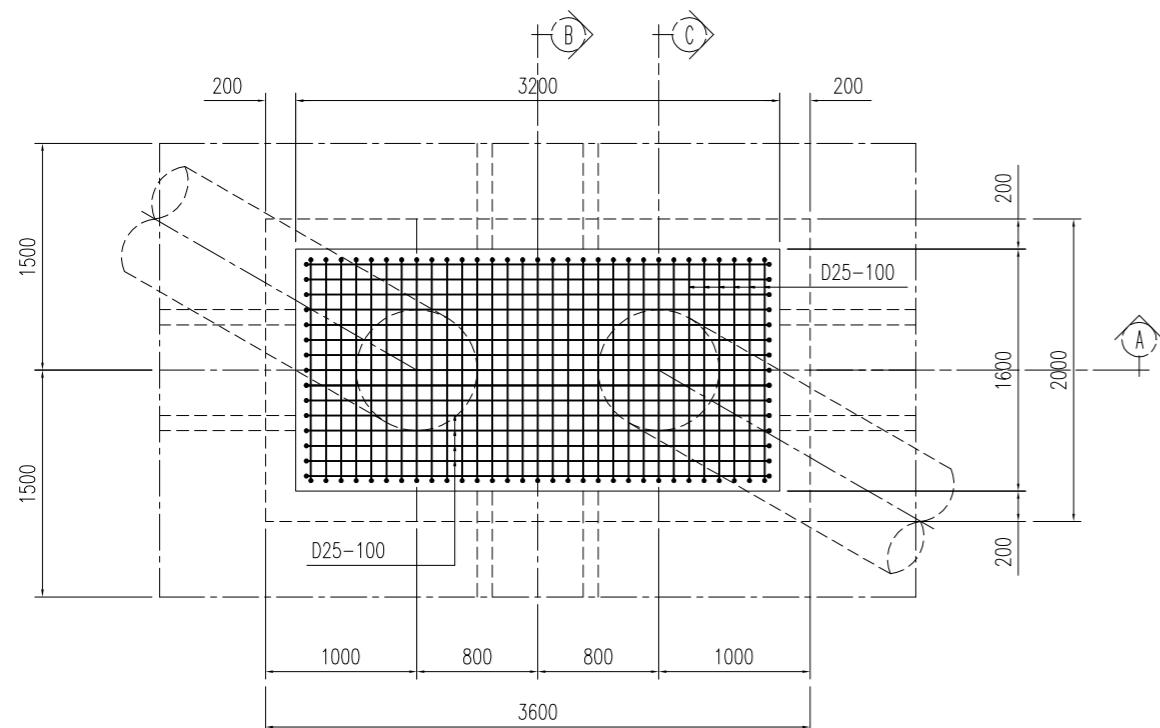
DETAIL PENULANGAN JOINT BALOK TIPE JIB 1
